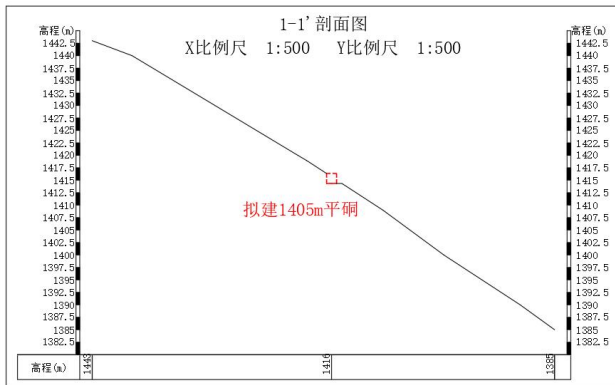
拟建出渣硐口 1405m 平硐剖面图
